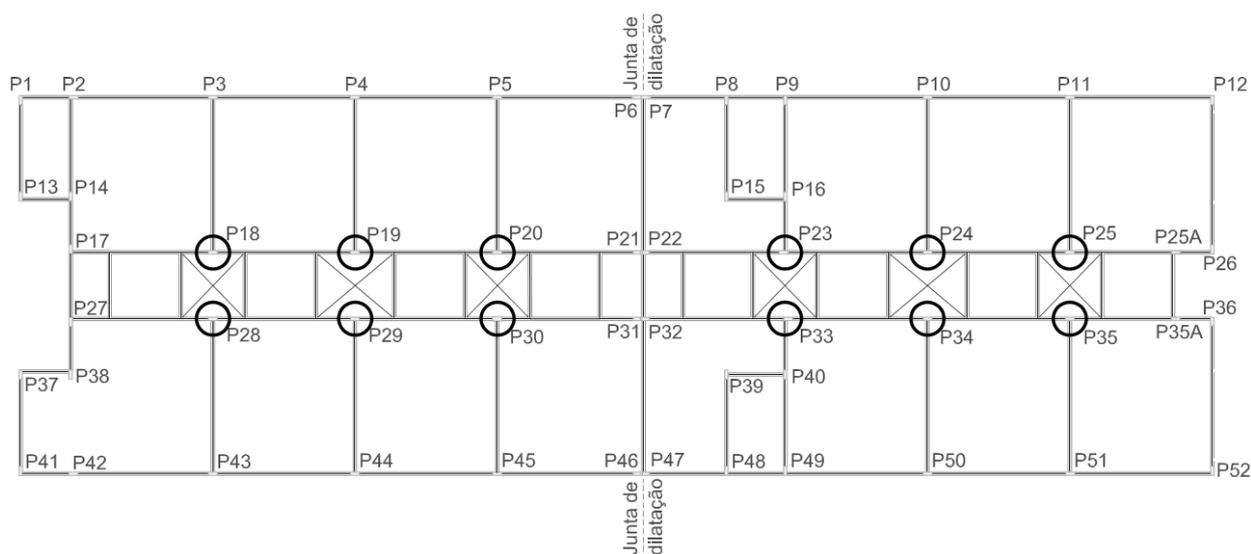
Planta de forma do pavimento tipo localizando os pilares analisados.
